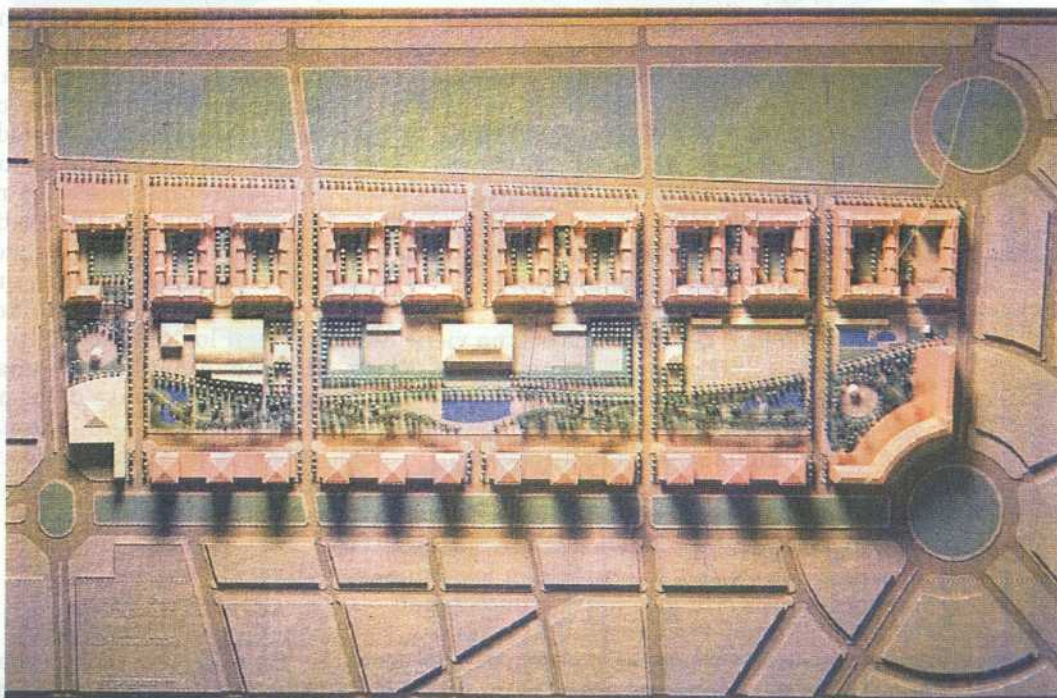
Planta del PP II 10 "Garbinet-Norte"
